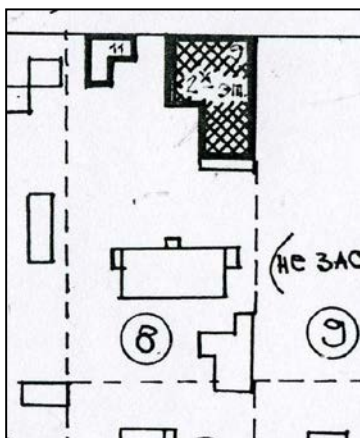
, 14. Схема границ усадьбы. Опорный план и план красных линий. Чита. 1956 г.
